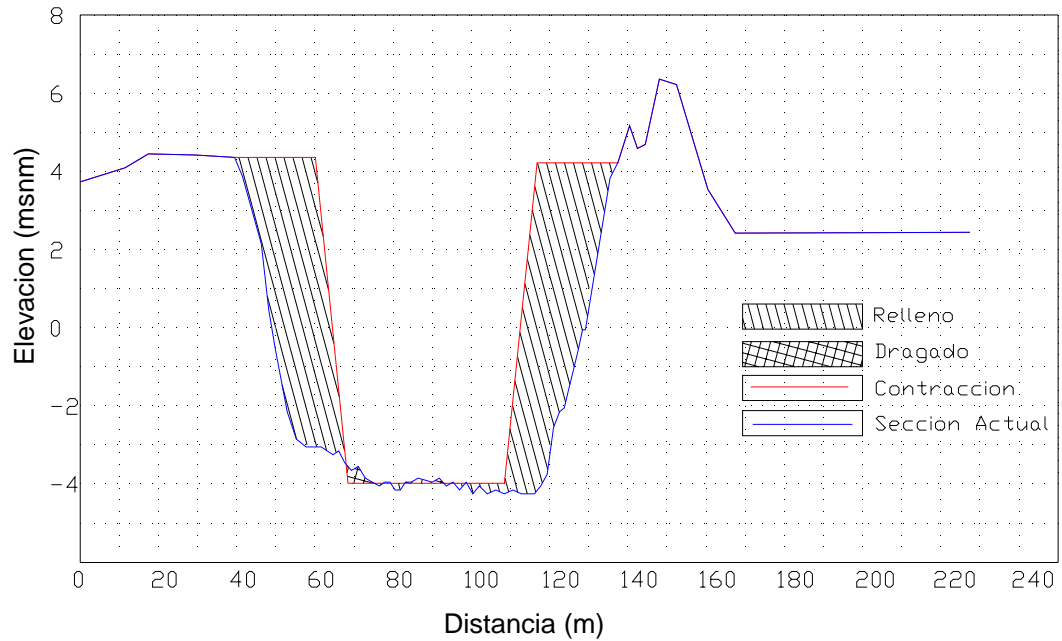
Sección transversal km 72 - Contracción No. 3
